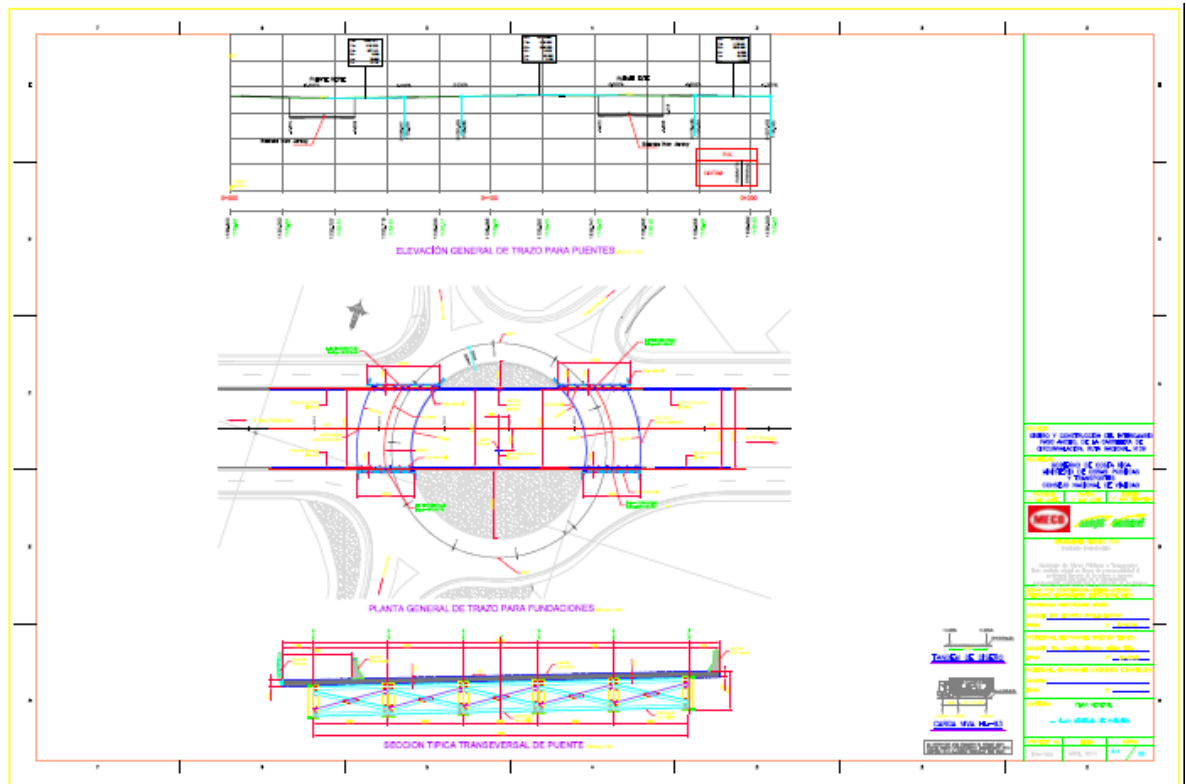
Plano constructivo rotonda de Paso Ancho
